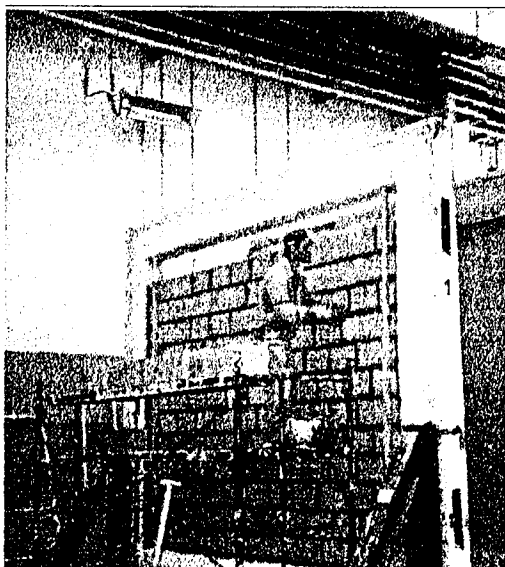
Montaje de la muestra H 25 en un marco de hormigón prefabricado
